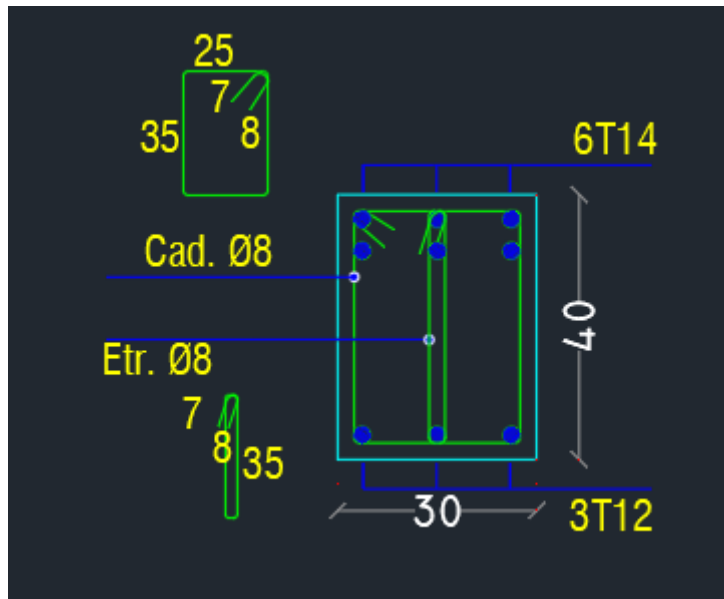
Schéma de ferrailage des longrines (30x40)
